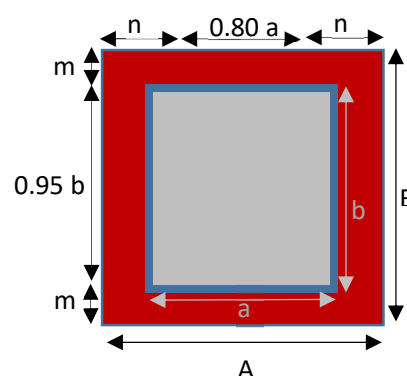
Vista en planta de la columna y placa base teoría McCormac
